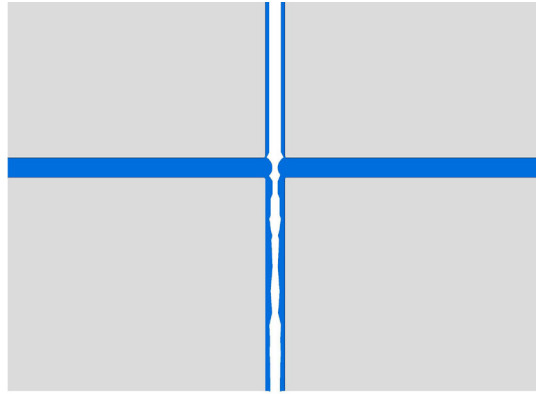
Imagen del desbordamiento de agua de la junta horizontal lisa de 5 mm en su encuentro con la junta vertical. Alzado desde el interior de la cámara de aire.
